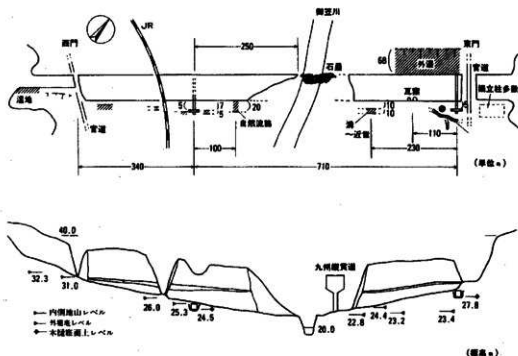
水城跡の平面図（上図）及び推定断面図（下図）
